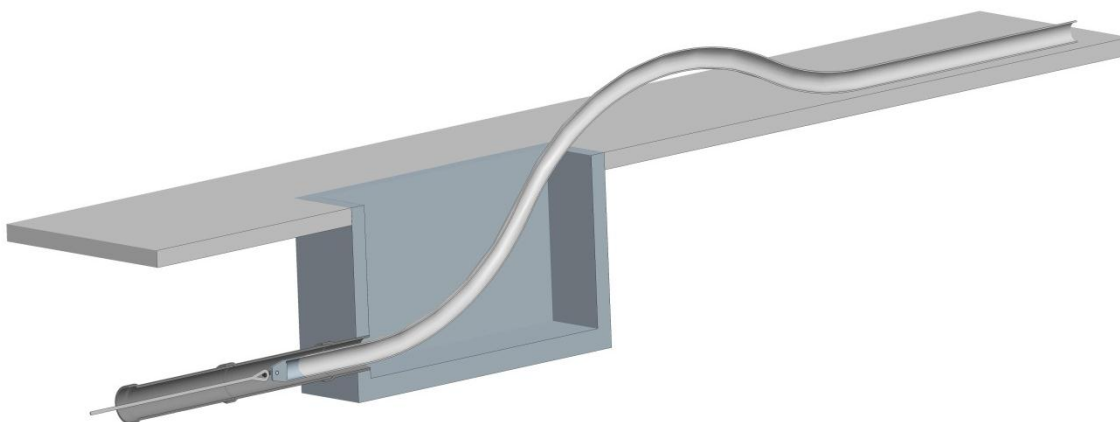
Verfahrensskizze - Einbau querschnittsreduzierter Rohre in der Baugrube
